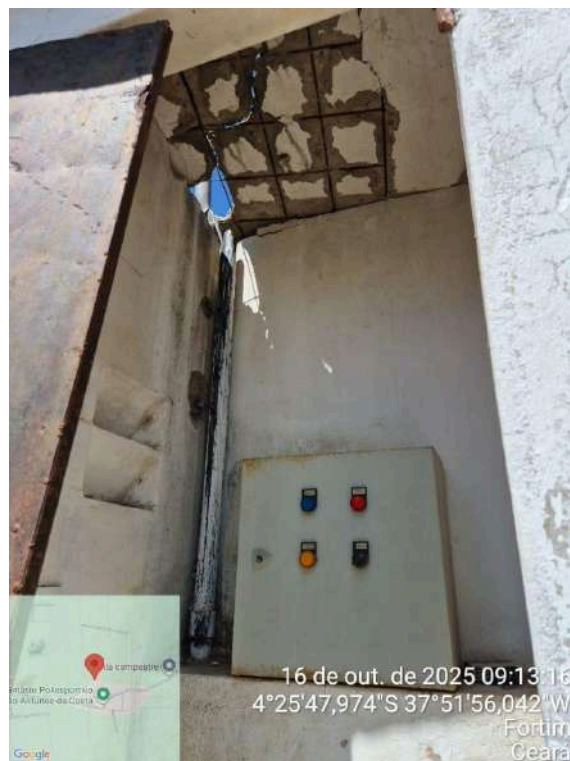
Poço PT-25: armadura do teto completamente degradada e exposta, sem proteger o quadro.
